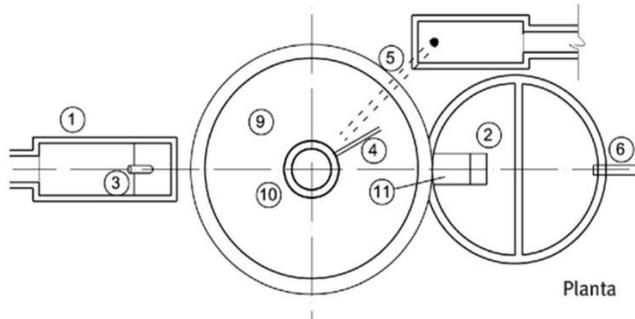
Esquema de la sección en planta del modelo Nicarao.⁶
